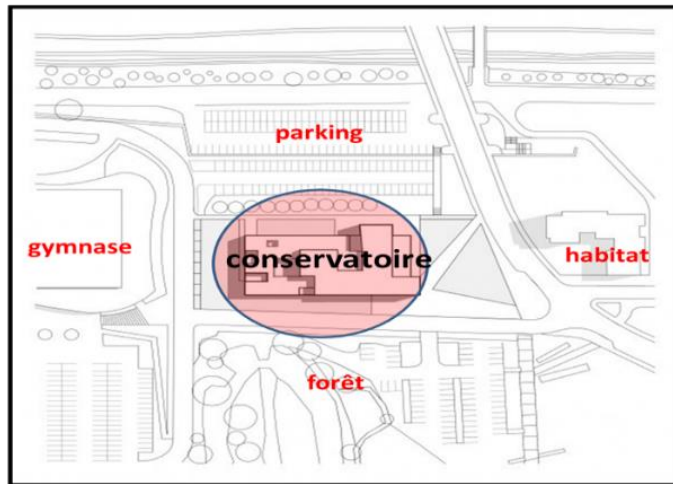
plan de masse de conservatoire Henri Dutilleux
